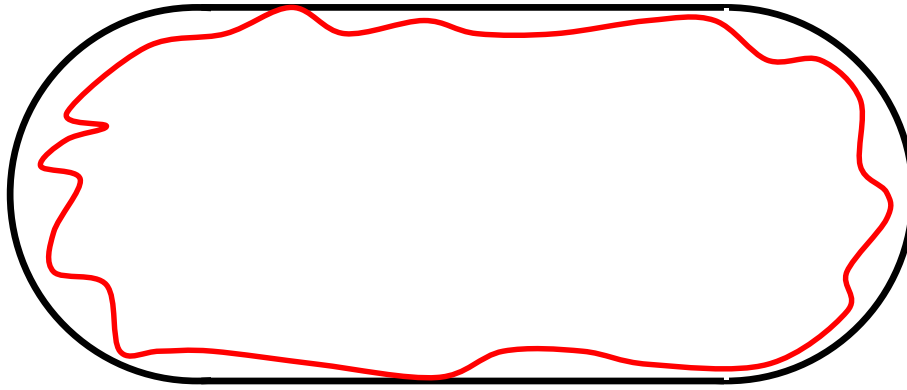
Schematischer Grundriss einer Kaverne: Für die Modellierung angenommene abdeckende Einhüllende (schwarz) und tatsächlich vorhandene Kavernenkontur (rot)
